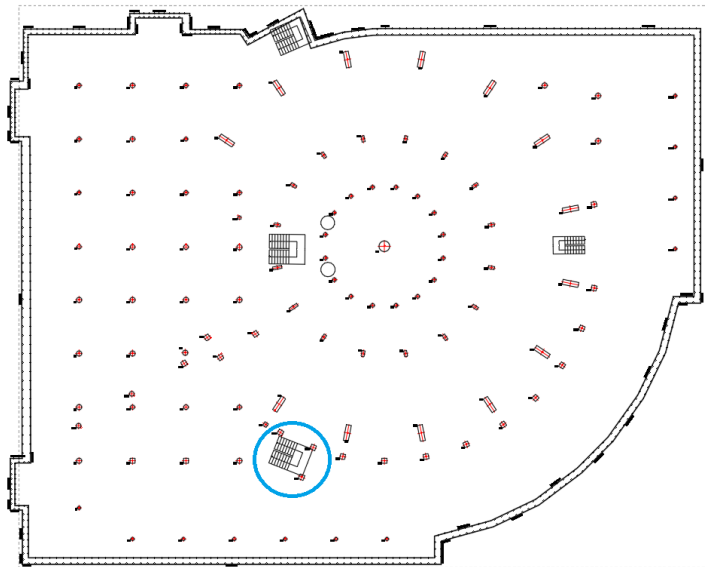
Situación Escalera 1 en el interior del edificio, planta Sótano 2.
